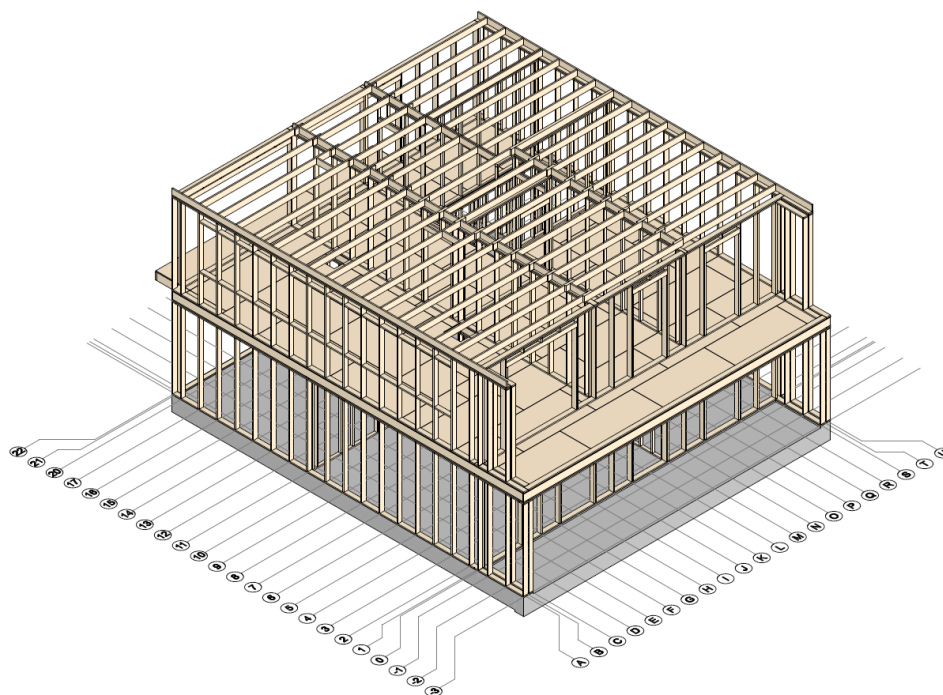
Axonometria estrutural com o piso térreo, as paredes e o tecto do piso 1.
